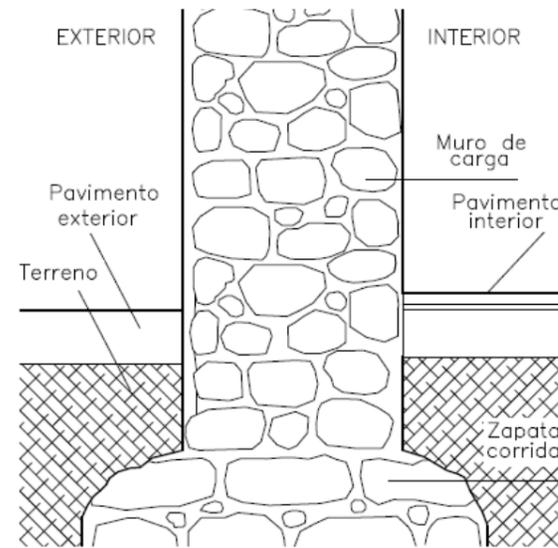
Detalle constructivo. 2014. Fuente: elaboración propia.
